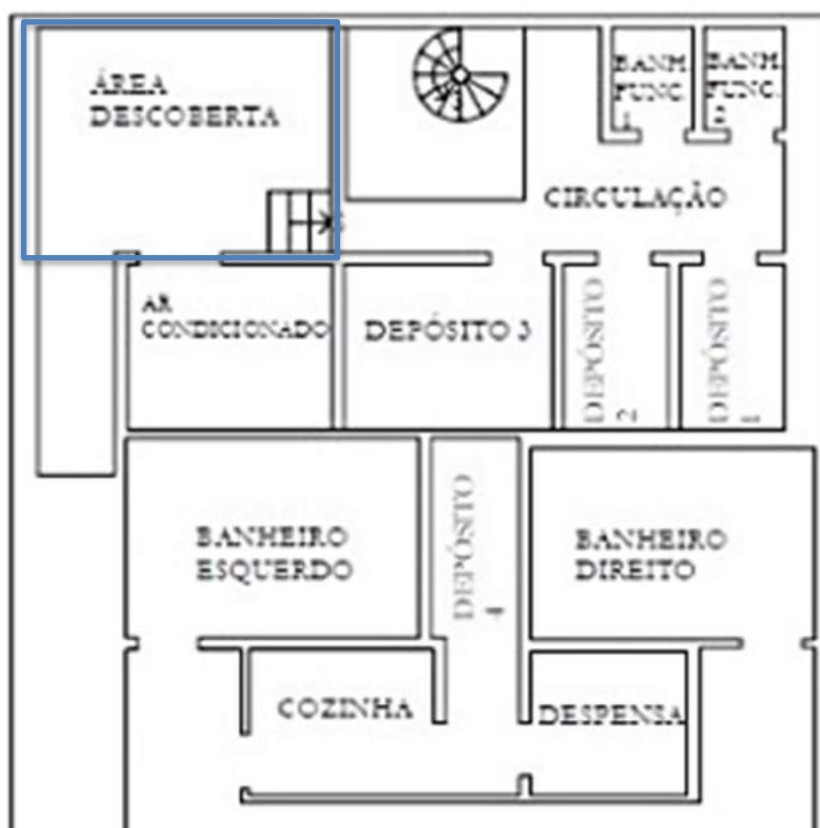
ÁREA DESCOBERTA, CONTINUAÇÃO.
